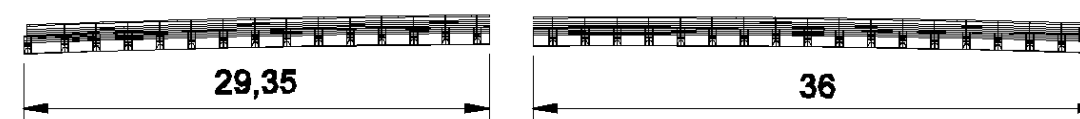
Figura II: ALZADO DE LOS DOS MÓDULOS DEL TABLERO (IZDA: LADO OBERLAND ST; DCHA: LADO TEMPELHOF)
